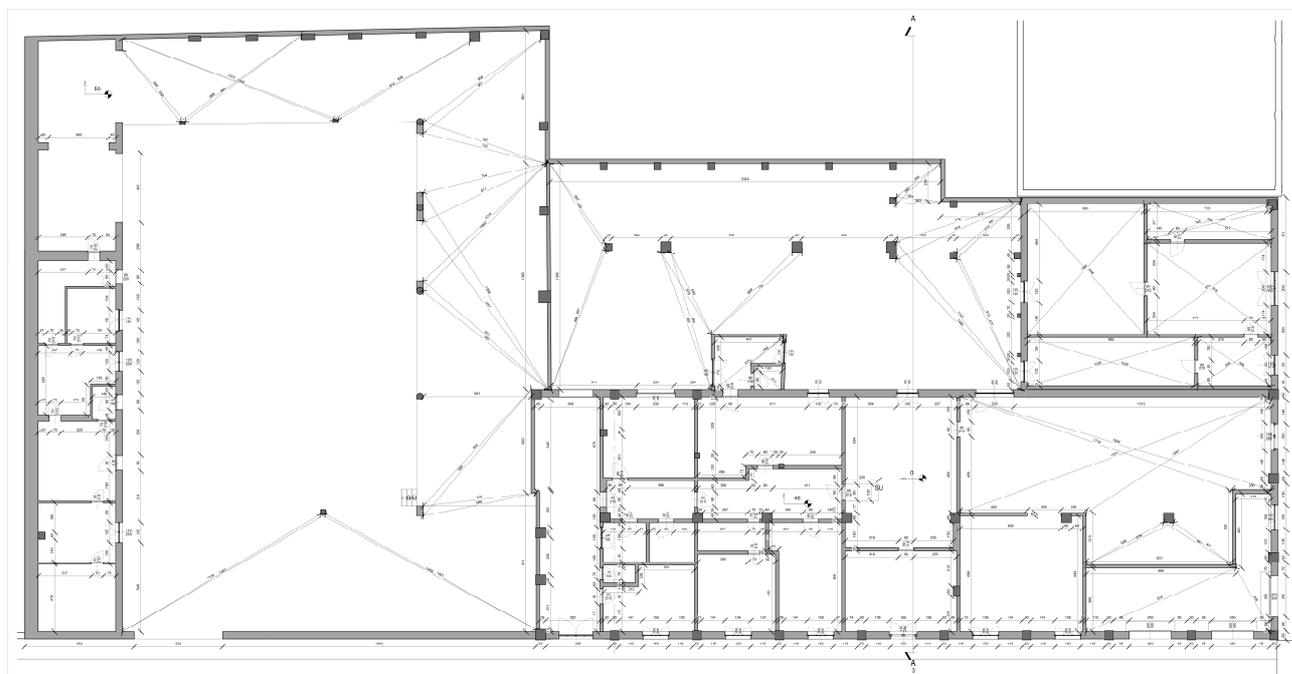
Pianta Rilievo (Tav. n°2 scala 1:100)
